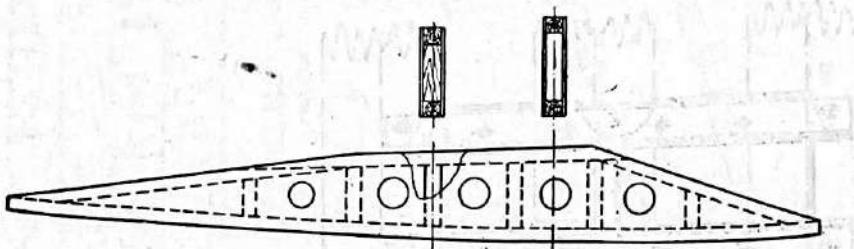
Фундаментная коробчатая kleенная балка с применением бакелизированной фанеры.
